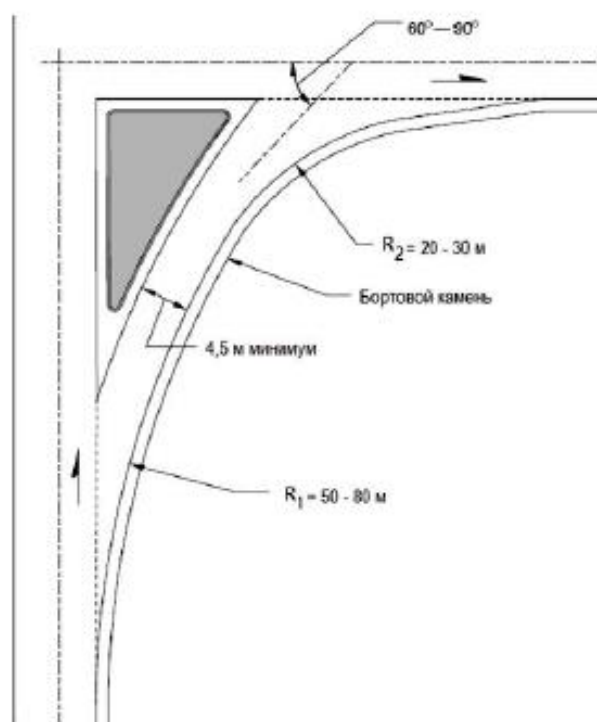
Планировка островка, рекомендуемая для поворотного потока, состоящего из легковых автомобилей
